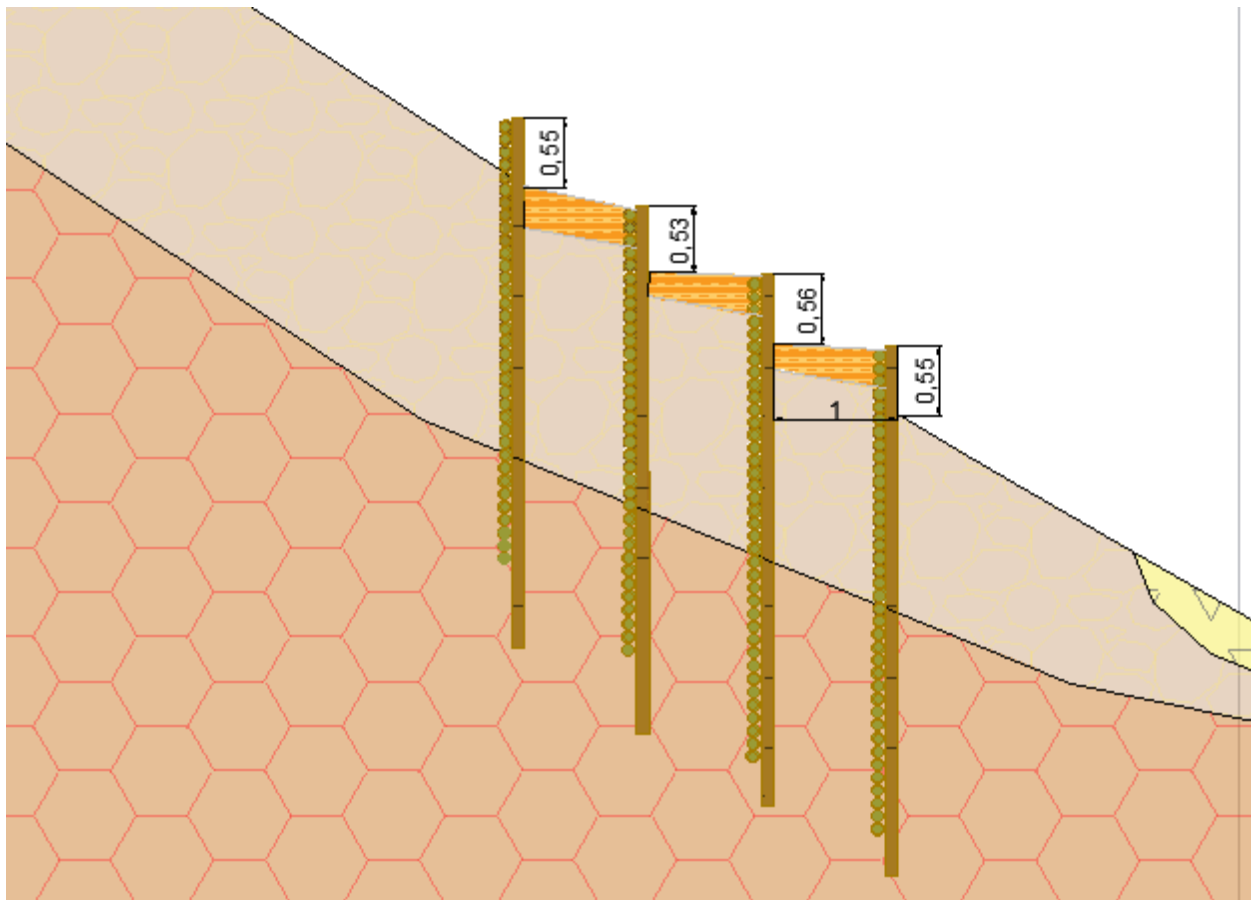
Trinchos ubicados en el perfil topográfico. Fuente: Propia
